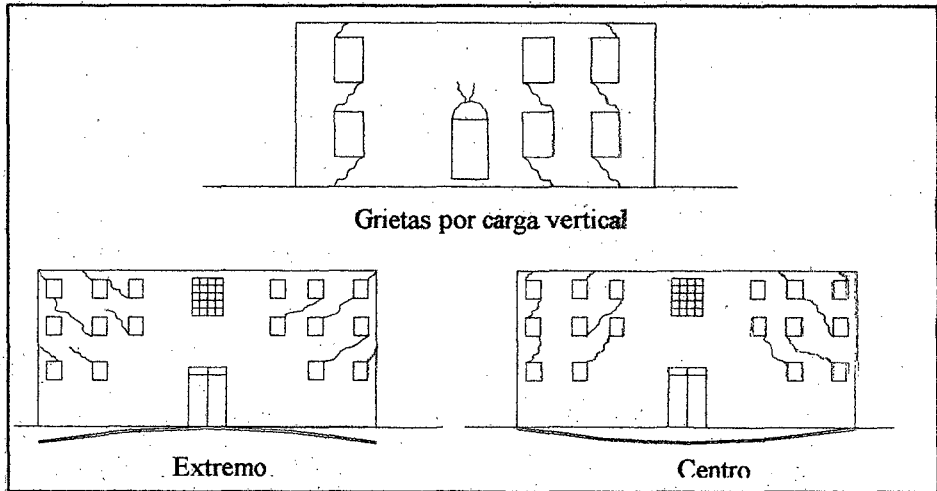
Agrietamiento típico en las fachadas de edificios de albañilería
